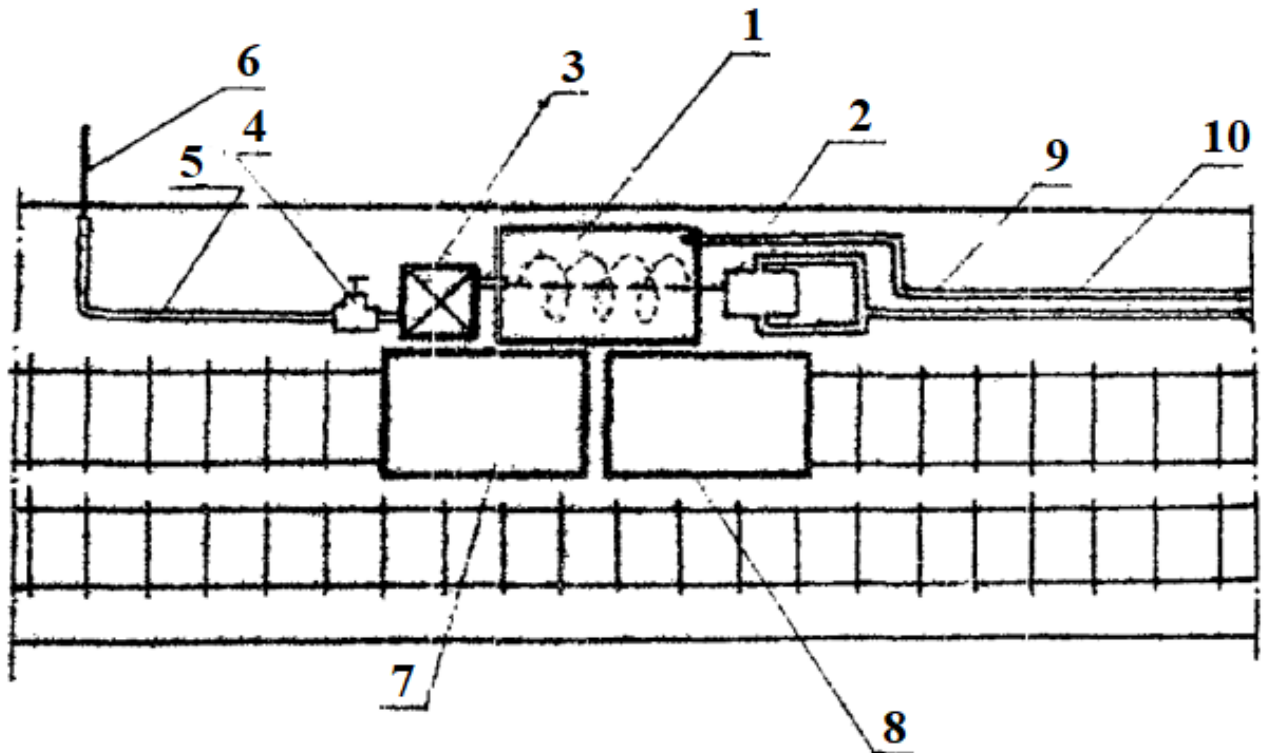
Схема розташування обладнання у виробці: 1 - вагонетка-змішувач; 2 - пневматичний двигун; 3 - насос; 4 - запірний кран; 5 - нагнітальний шланг; 6 - тампонажний патрубок; 7 - вагонетка з цементом; 8 - вагонетка з піском; 9 - водяний став; 10 - став стислого повітря.
